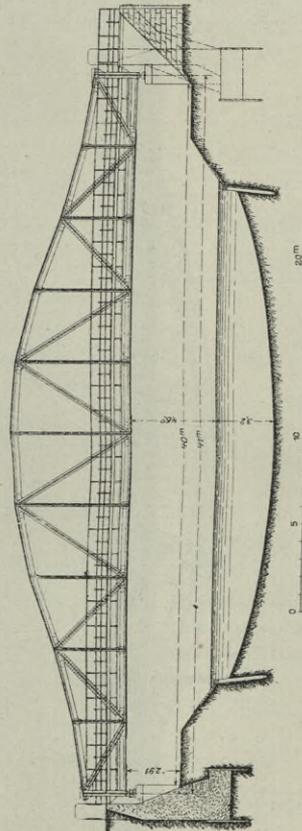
Landstraßen-Brücke über die Spree-Oder-Wasserstraße.
